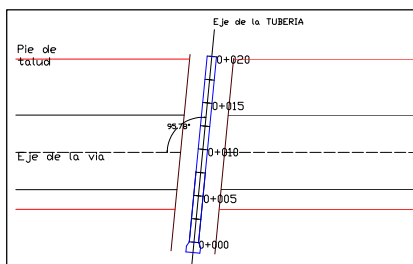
Vista en planta de la excavación y ubicación de la tubería
